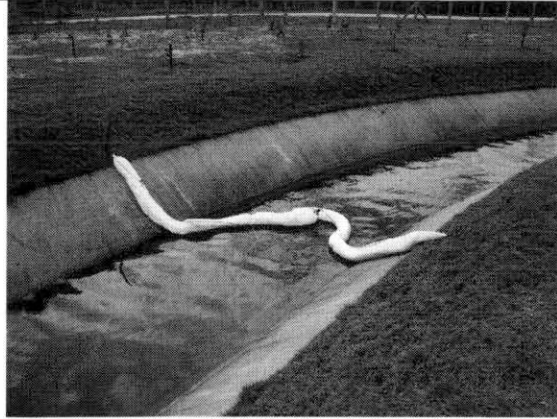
Bóias de contenção colocadas dentro do canal para evitar contaminação no mangue.
